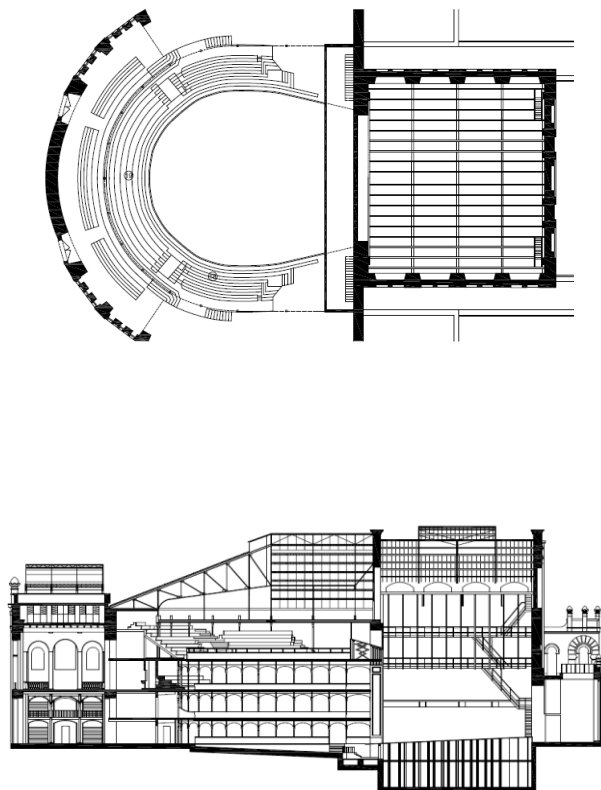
Planta y sección Gran Teatro Falla, Cádiz
